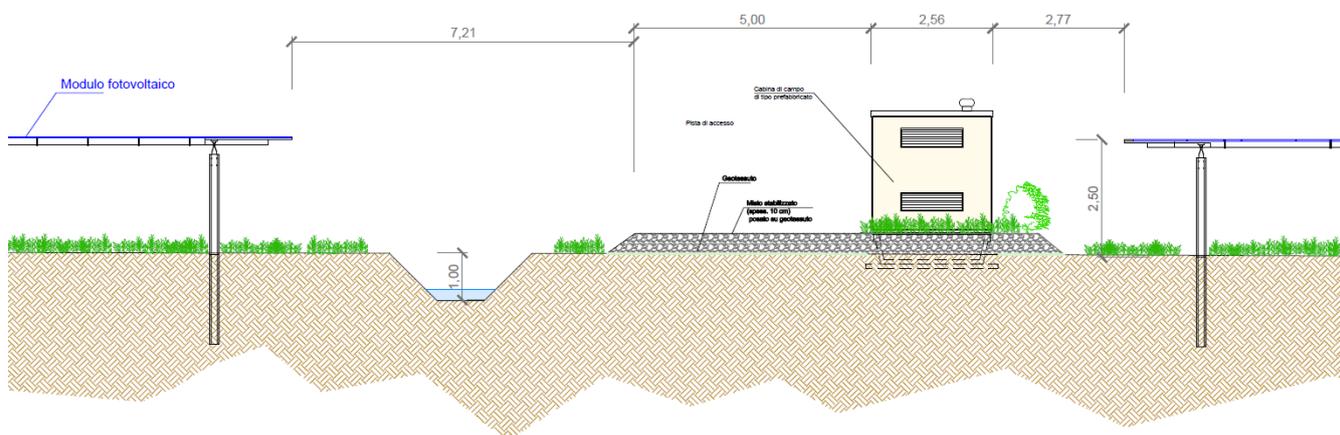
sezione tipo della pista interna di gestione dell'impianto
